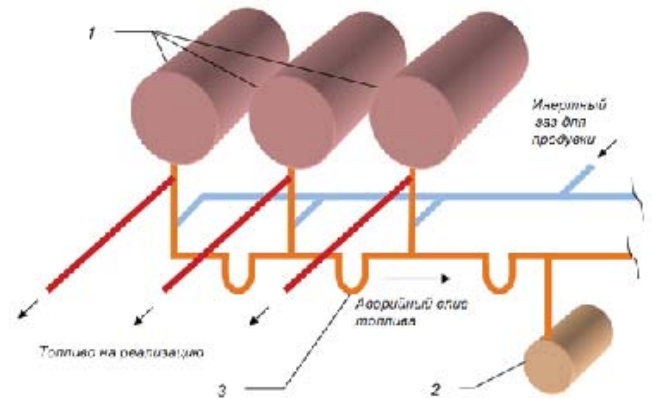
Схема системы аварийного слива топлива из резервуаров: 1 – резервуары для хранения топлива; 2 – аварийная емкость; 3 – гидравлический затвор
